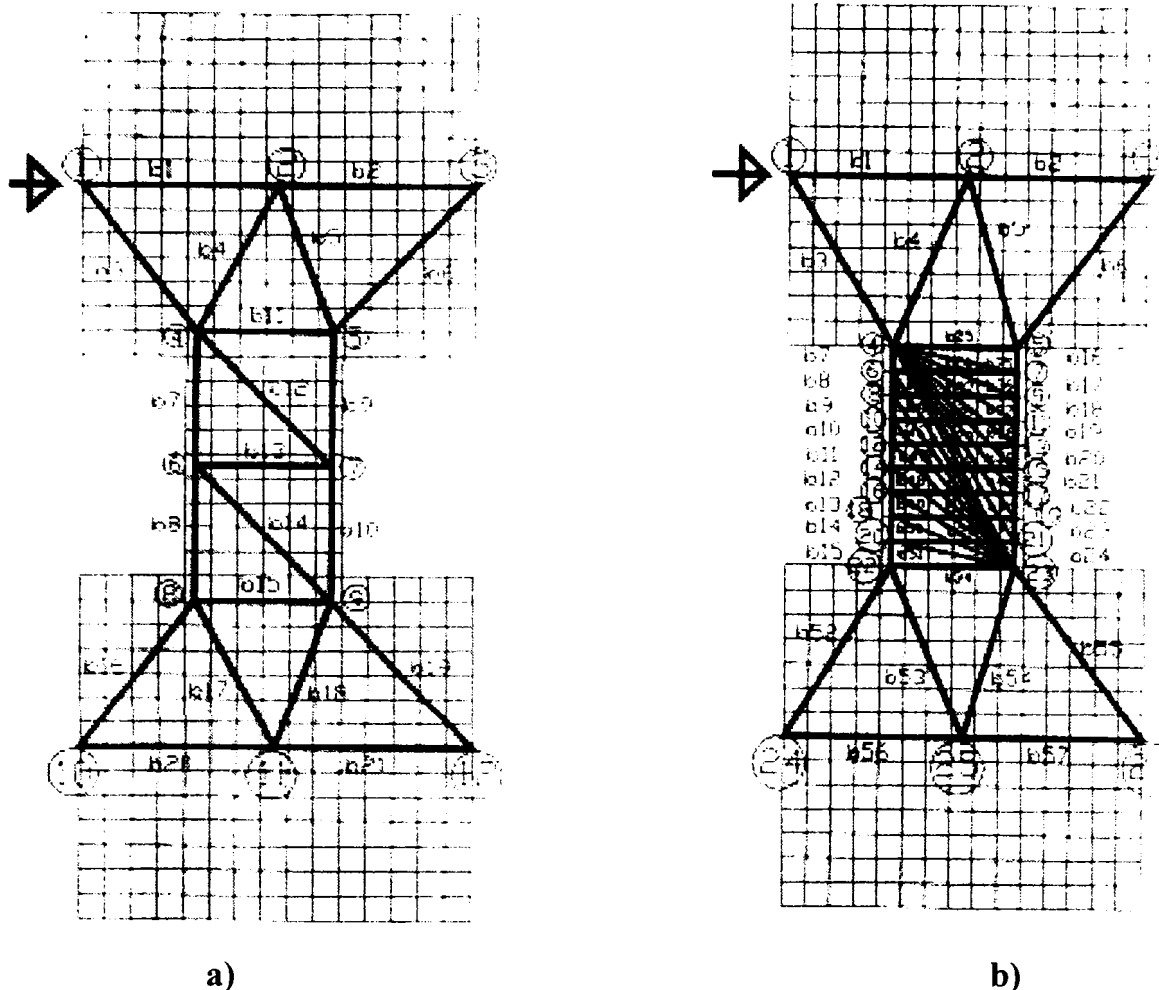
Modele de bare pentru armarea cu armătură longitudinală și etrieri
